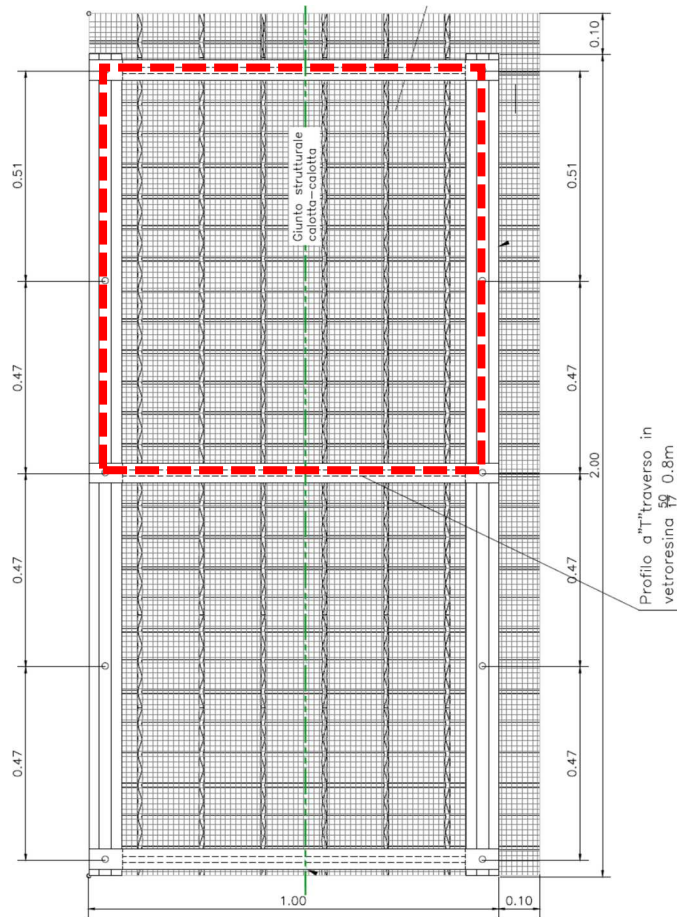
Valutazione area di influenza delle reti - Stralcio planimetrico
